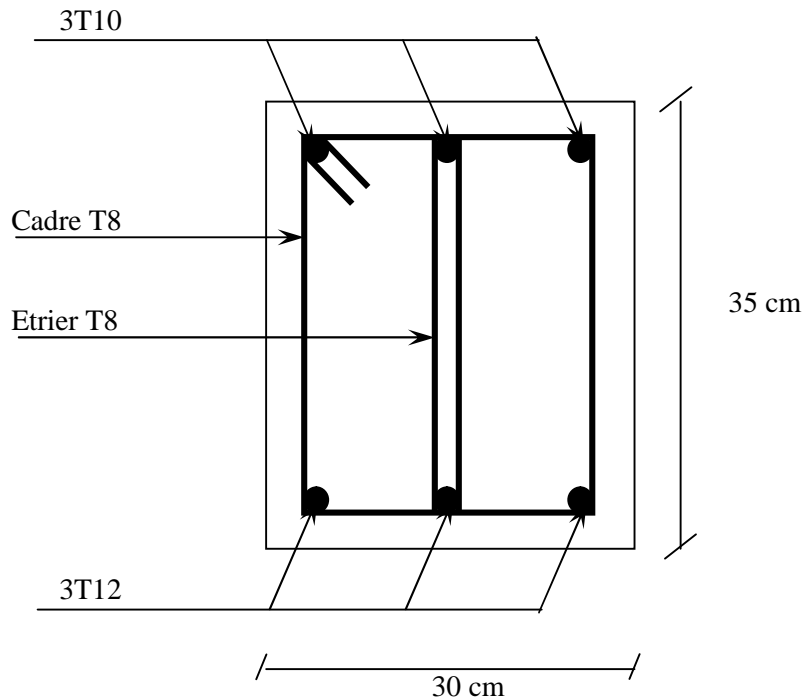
Schéma de ferrailage de la poutre de chaînage
